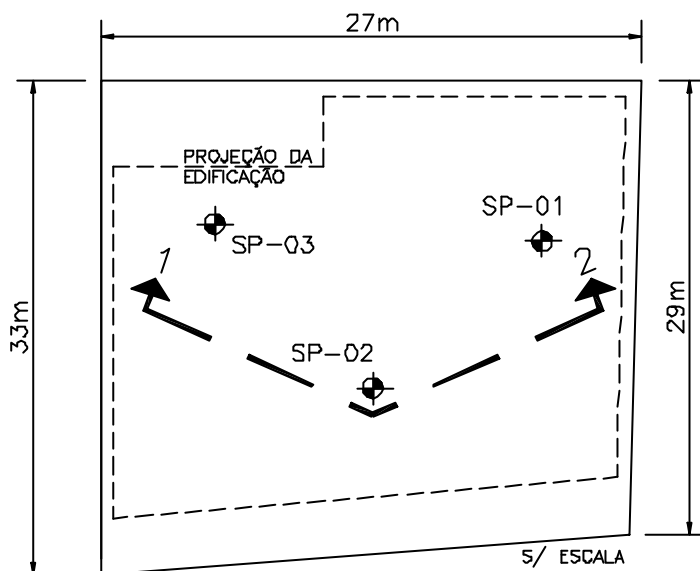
Croqui de Locação das Sondagens à Percussão realizados no terreno.
